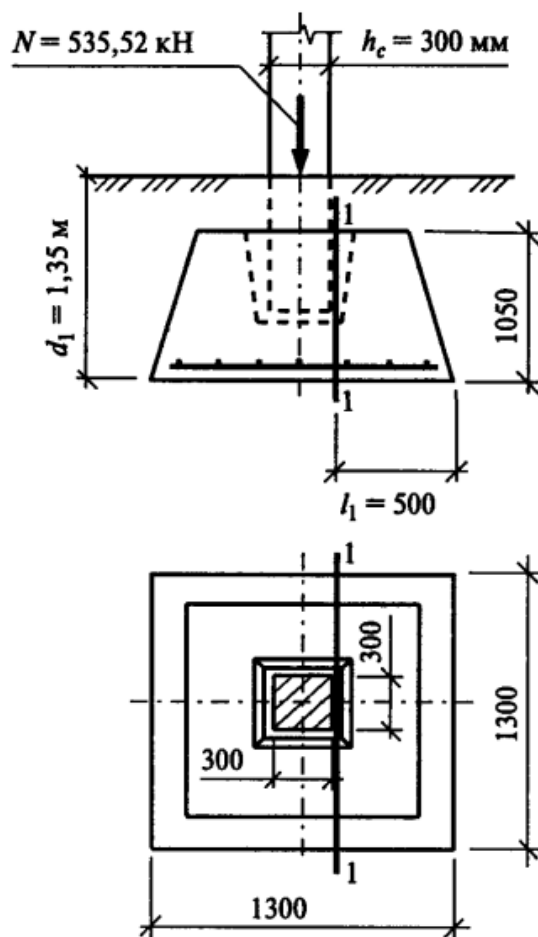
Расчетное сечение фундамента – к примеру 12.3
